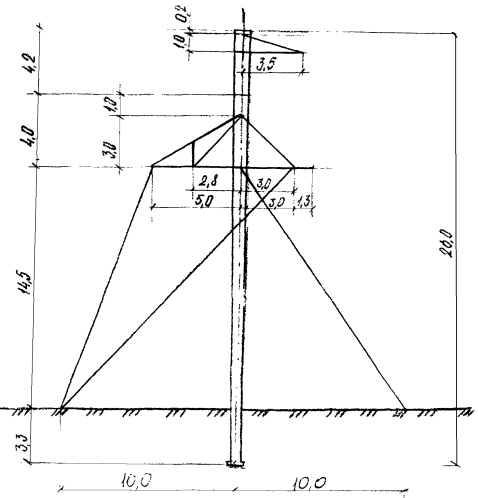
Одноцельные железобетонные опоры ВЛ 220 кВ
